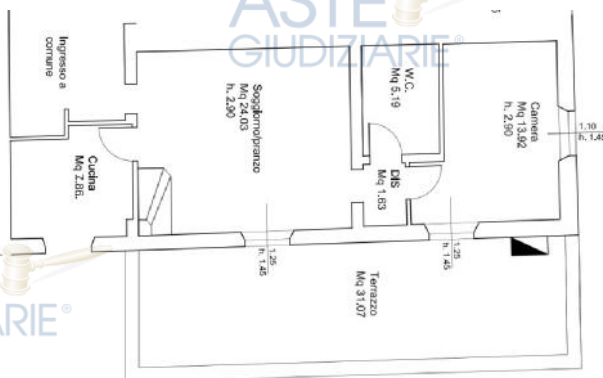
Planimetrie dello stato attuale Piano Terra
